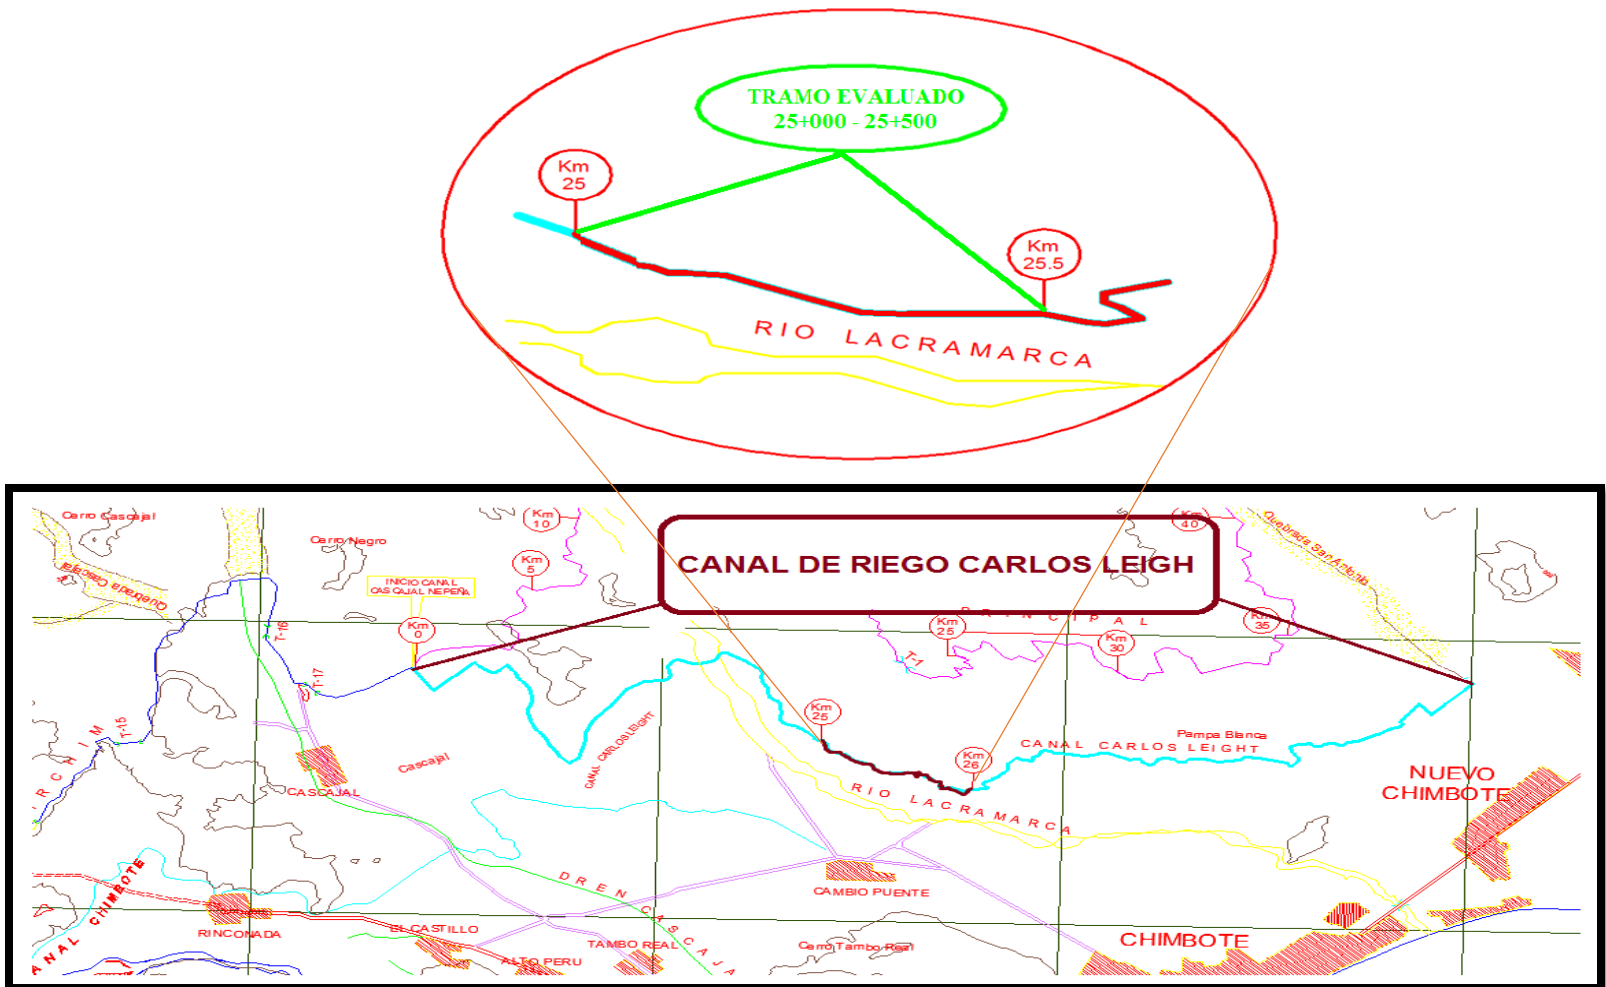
Vista en Planta del Canal de riego Carlos Leigh
